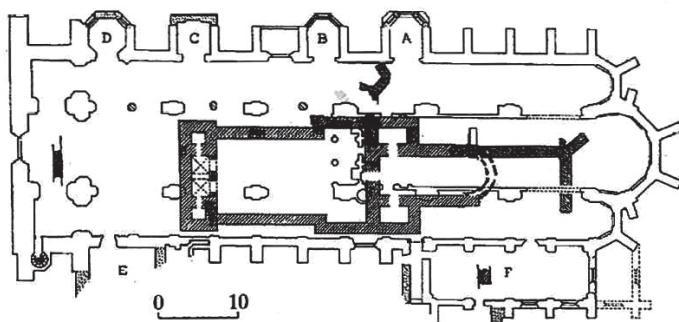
Grundriss der Sandkirche mit den eingezeichneten Fundamenten des romanischen Vorgängerbaus
